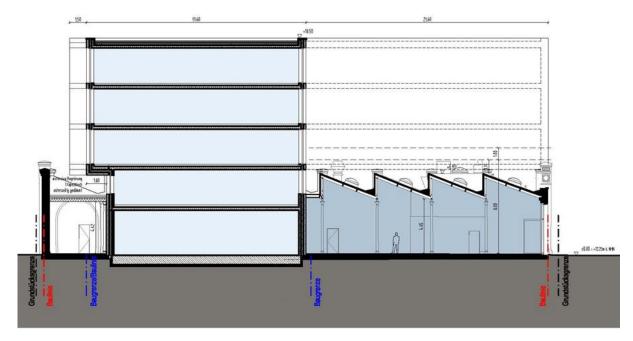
Schnitt mit eingerückter Nordfassade [Tchoban Voss Architekten Berlin, Stand: 04.10.2022]
